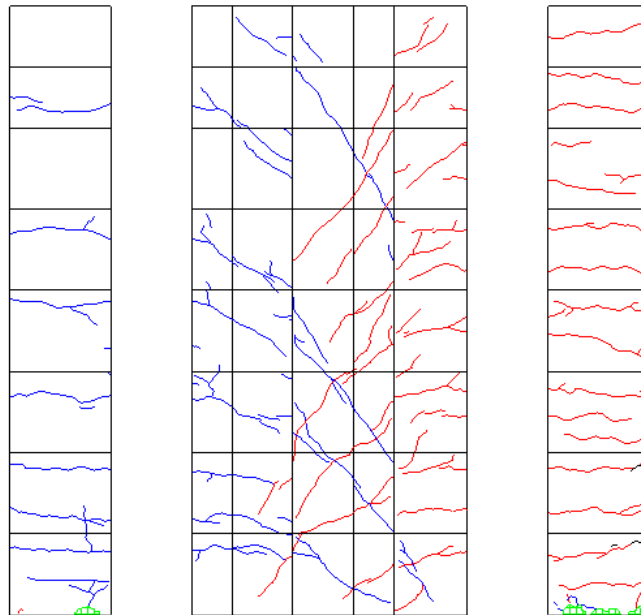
R=1/67②ひび割れ図
